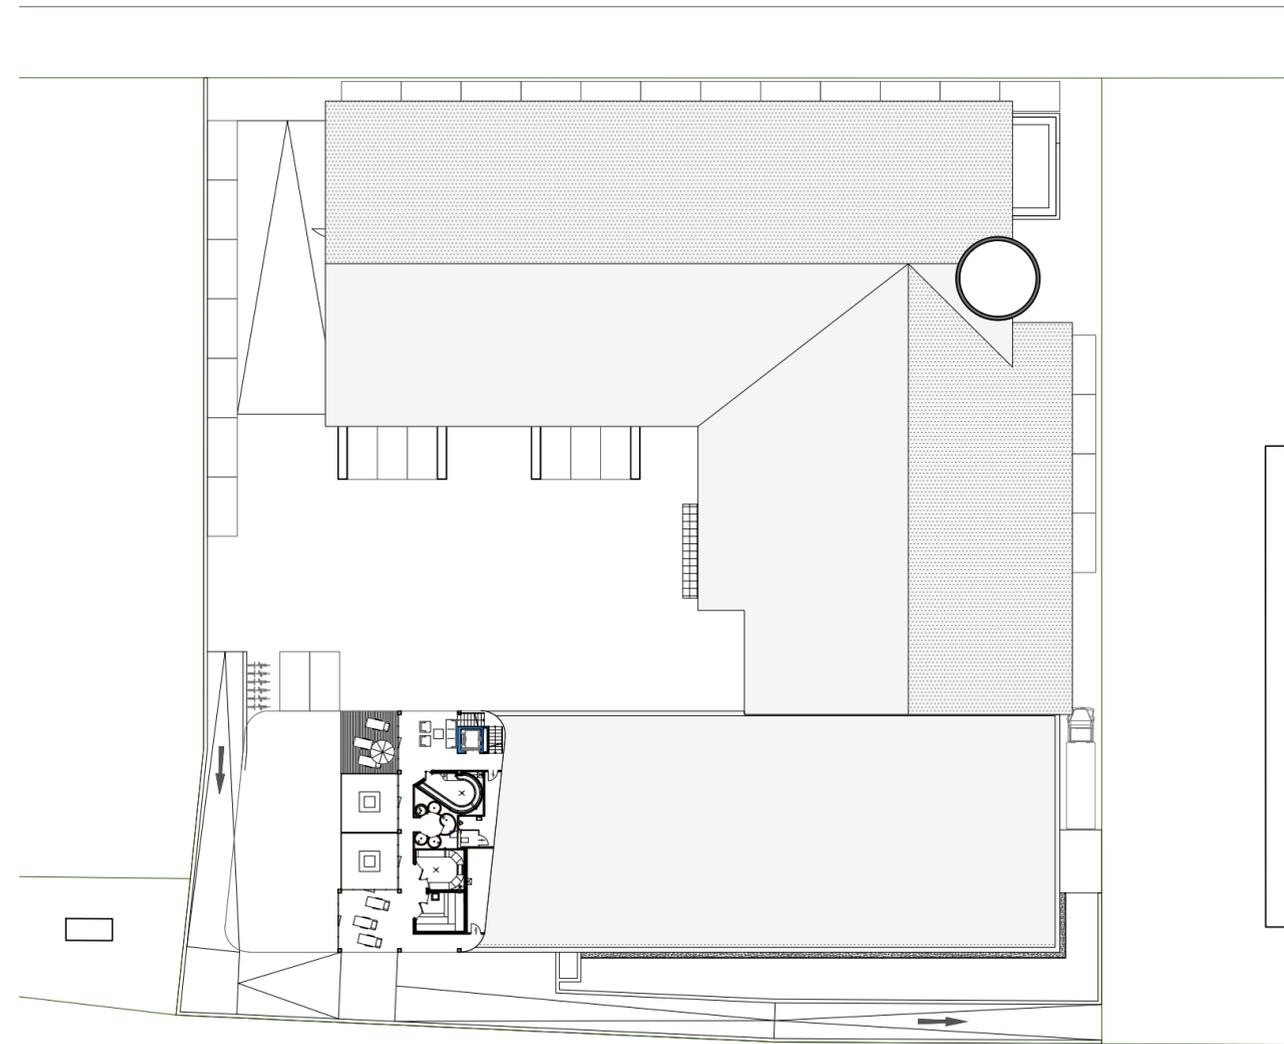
Vorentwurf III - Grundriss Dachgeschoß
